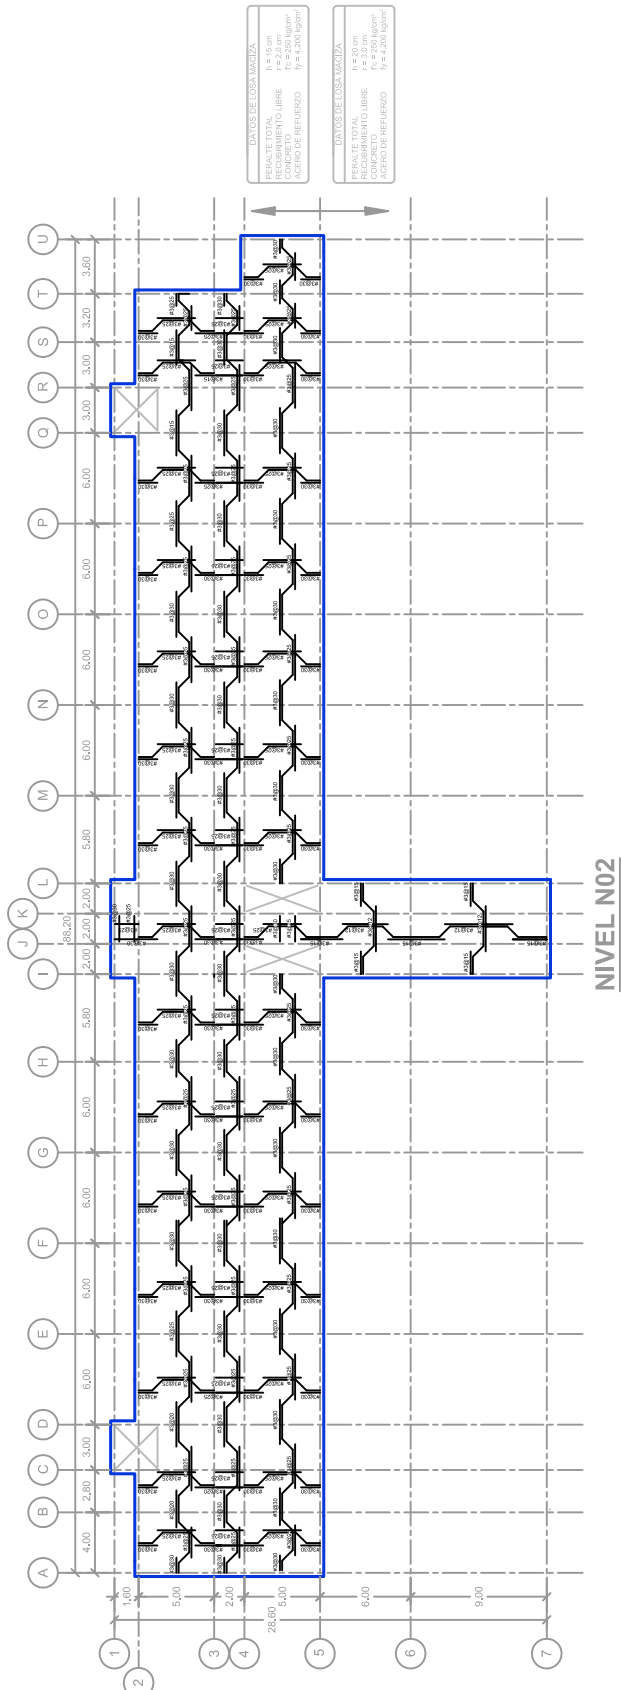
ARMADO DE LOSA DE CONCRETO REFORZADO PARA NIVEL N02
